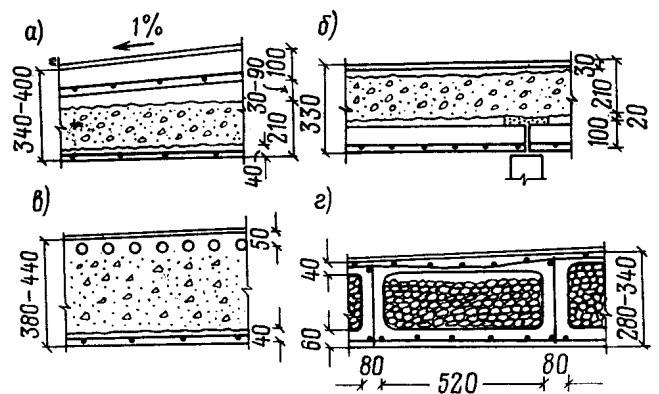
Поперечные сечения панельных конструкций легкой бетонной крыши
